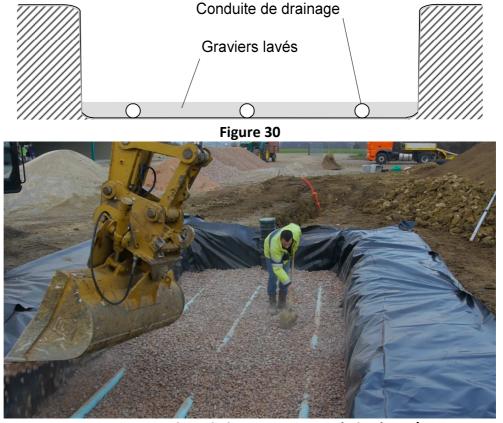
Mise en place de la pierre concassée lavée 10/40 mm
